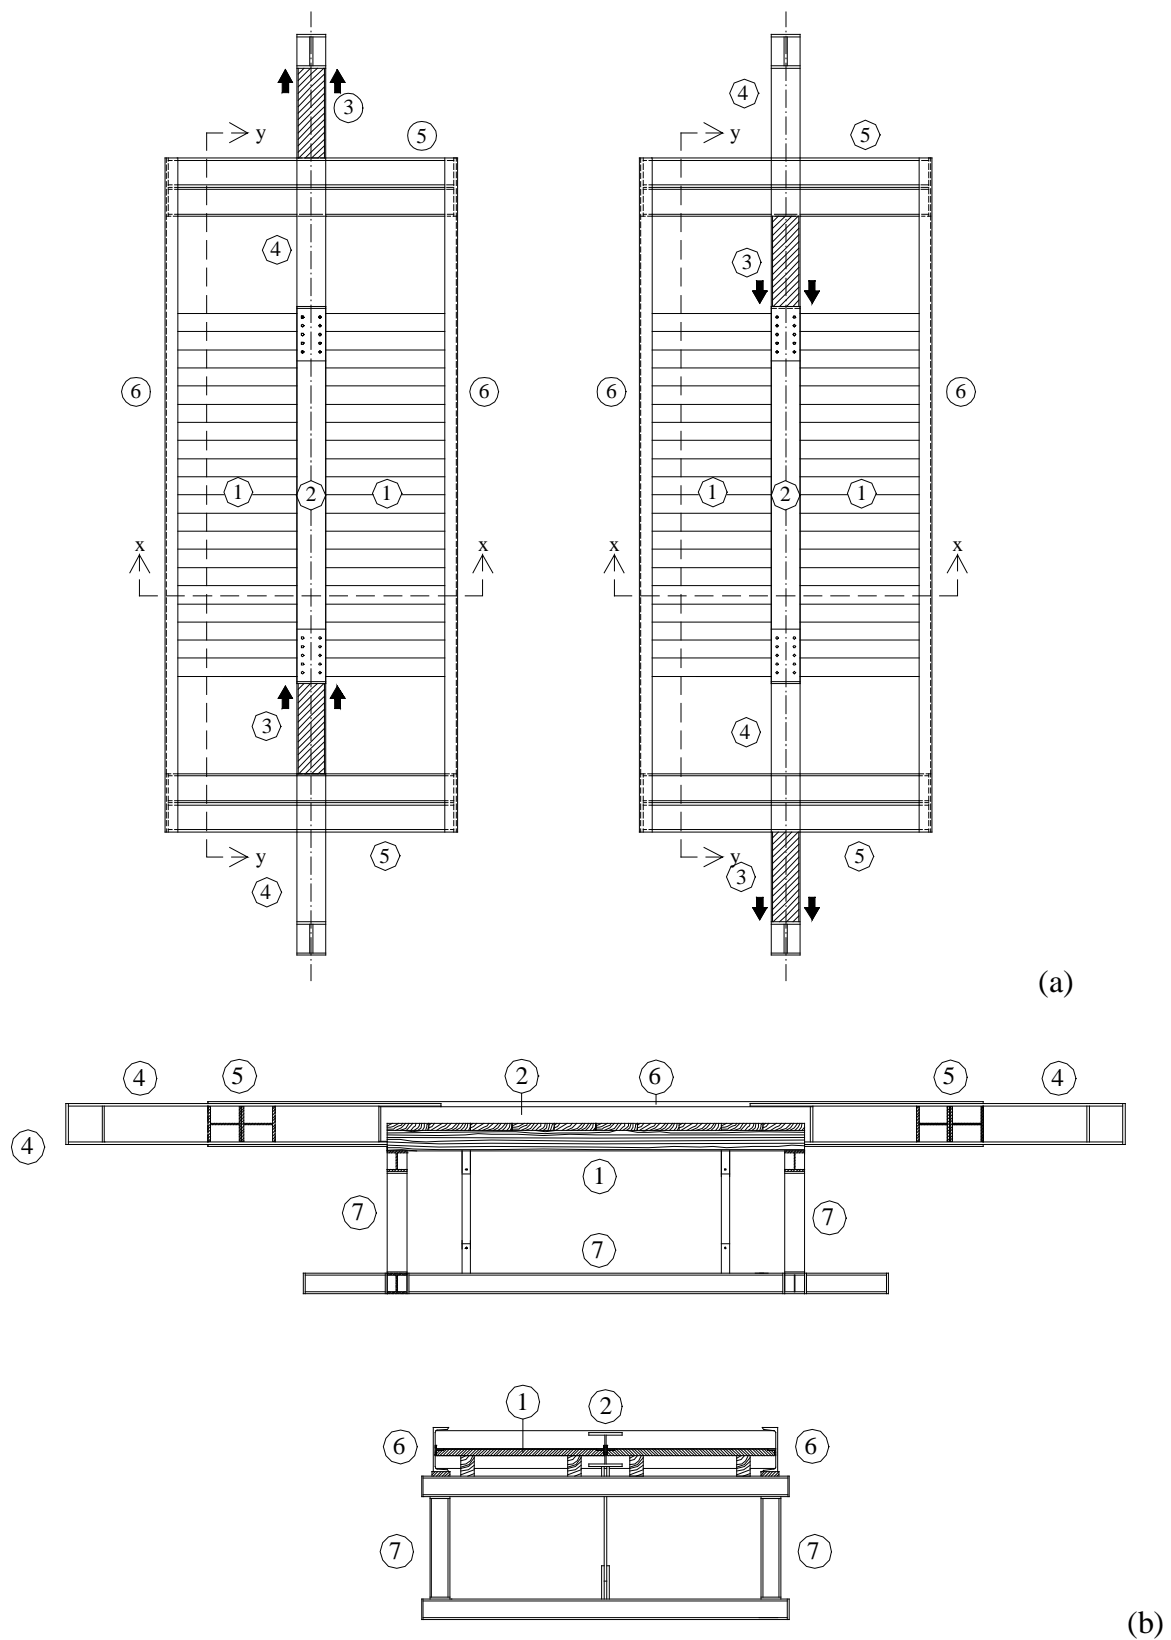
Pianta (a), sezione longitudinale e sezione trasversale (b) del provino nel banco di prova.
